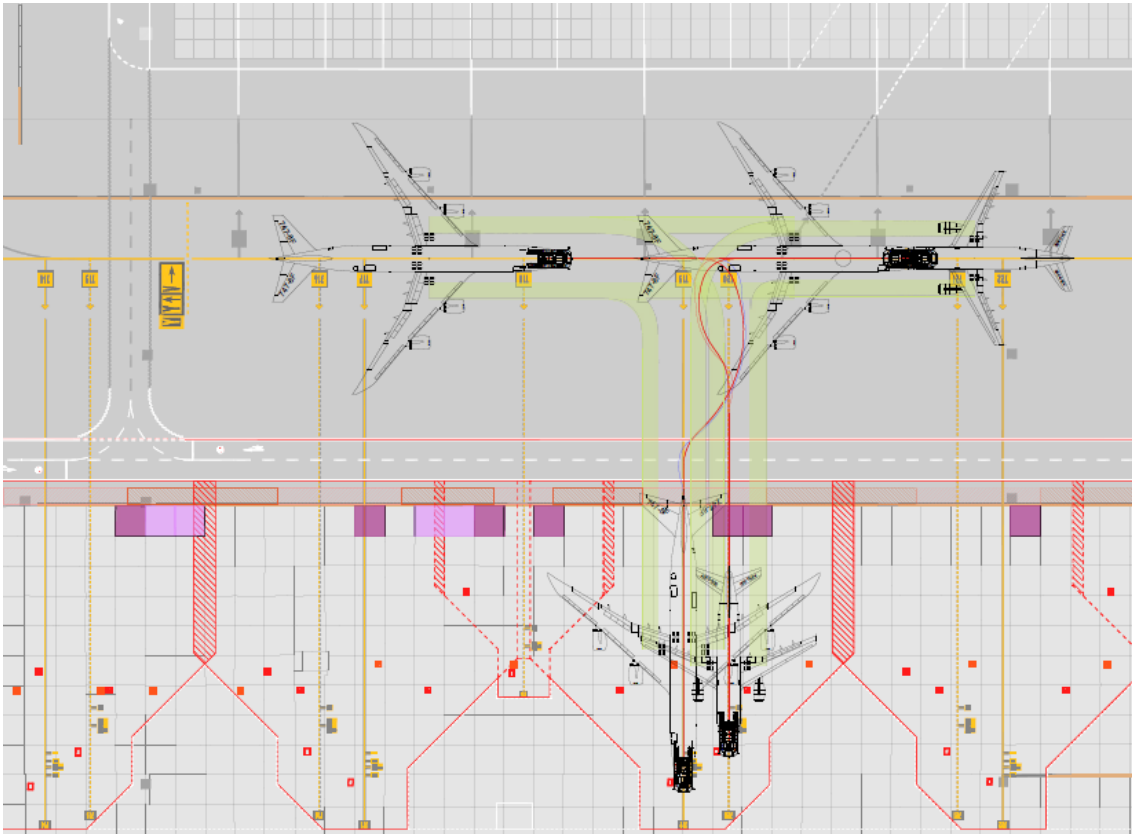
Verifica delle manovre per la definizione degli interventi di rinforzo sulle pavimentazioni rigide e flessibili.
